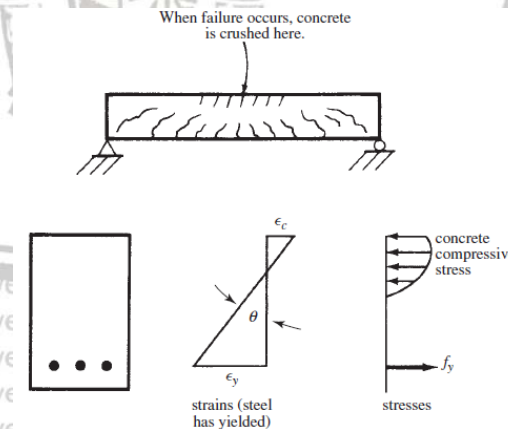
Balok pada Fase Concrete Cracked.
